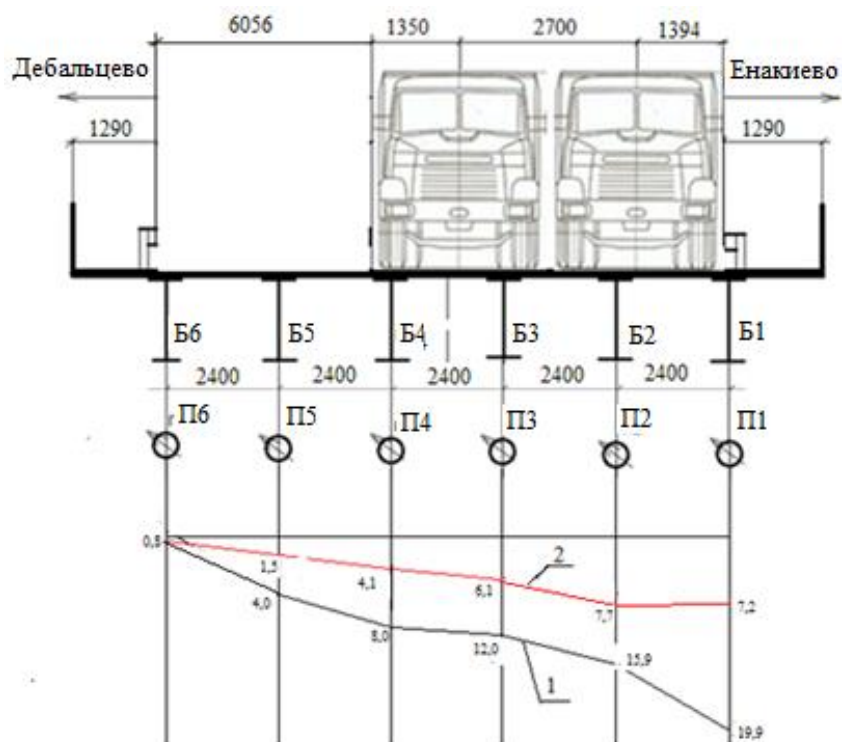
Размещение испытательной нагрузки по схемам 2 и 4
